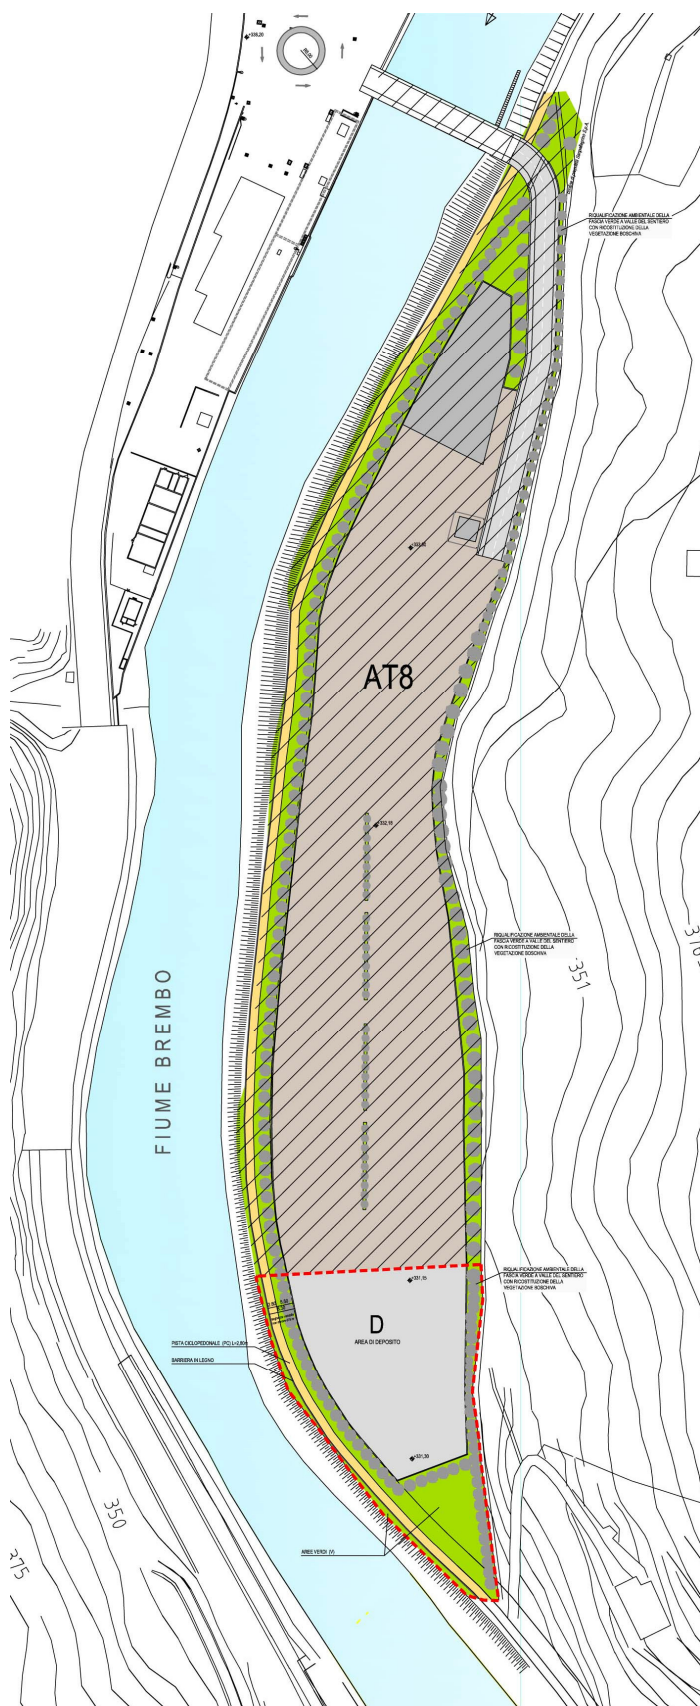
Planimetria di progetto con evidenziazione dell'area di intervento (tratteggio rosso)
